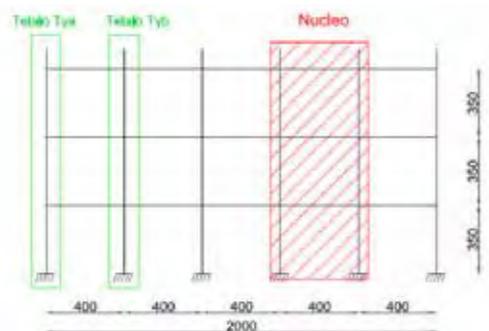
Prospetto dell'edificio tipo analizzato (misure in cm)
